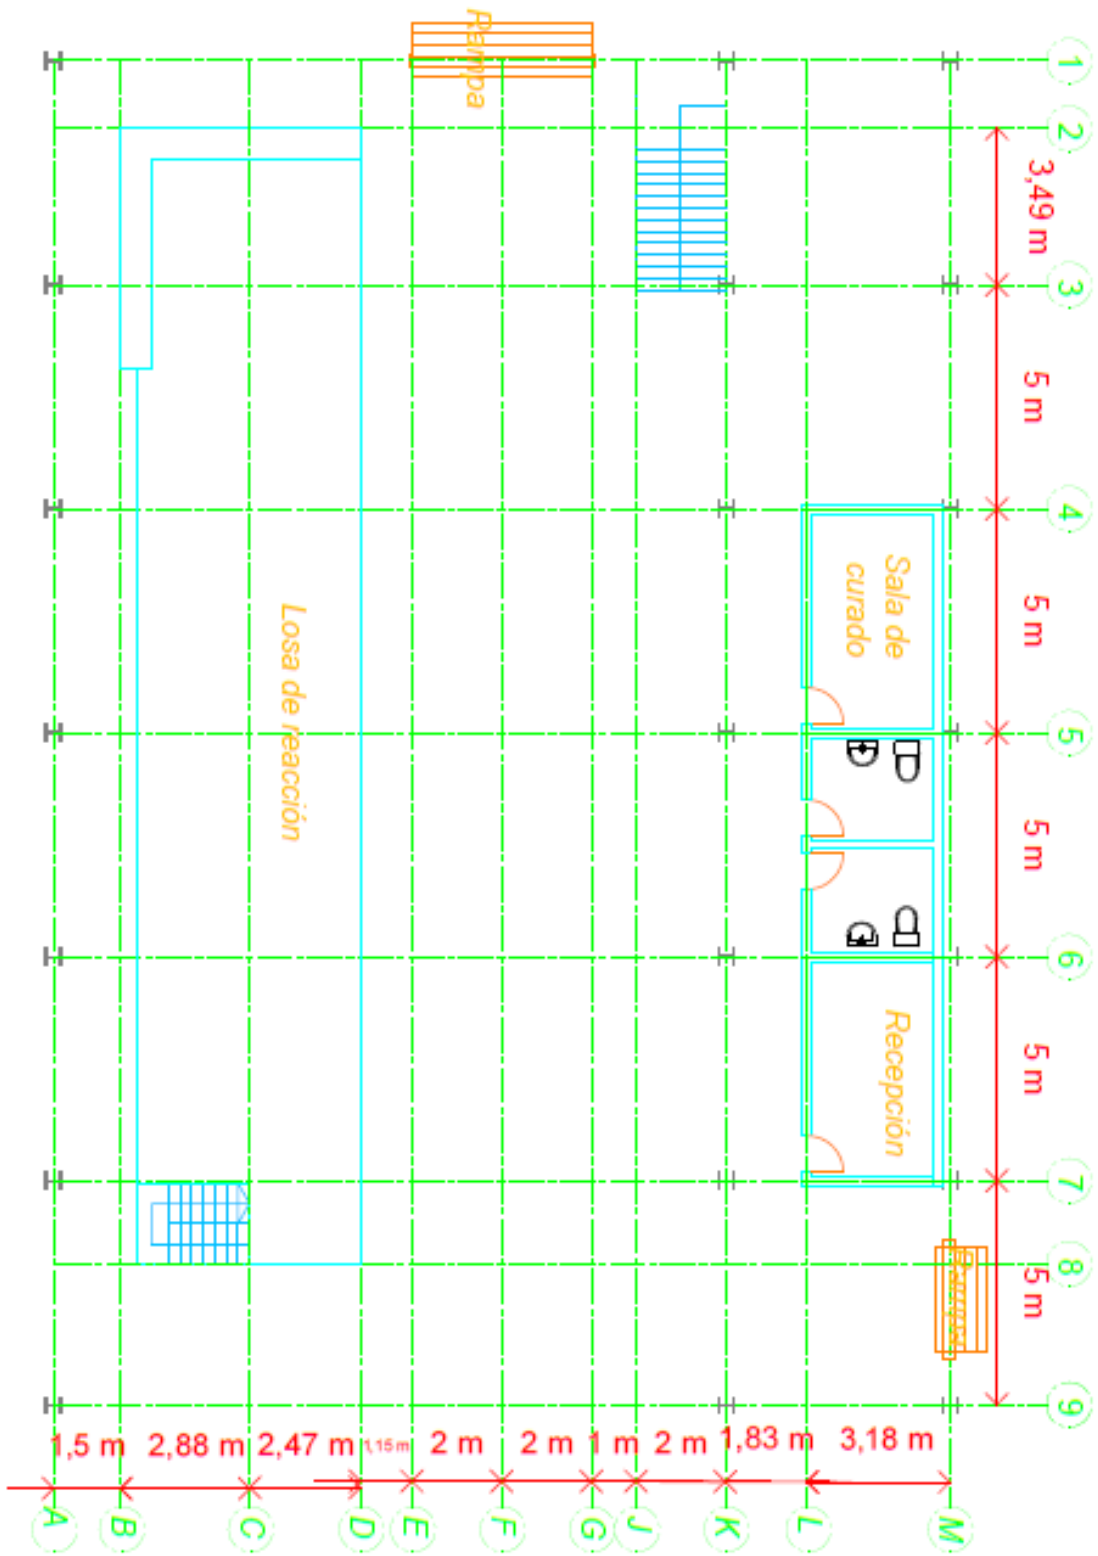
Planta estructura de acero primer nivel N. 0 [m].
